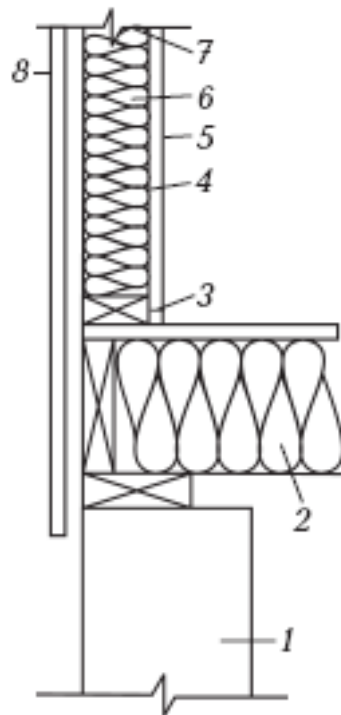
Изоляция каркасной стены: 1 – фундамент; 2 – утеплитель, уложенный в каркас пола; 3 – герметичный стык пароизоляции стены и пола; 4 – пароизоляция; 5 – внутренняя отделка; 6 – теплоизоляция стены в полостях каркаса; 7 – ветро- и гидроизоляция; 8 – наружная обшивка
